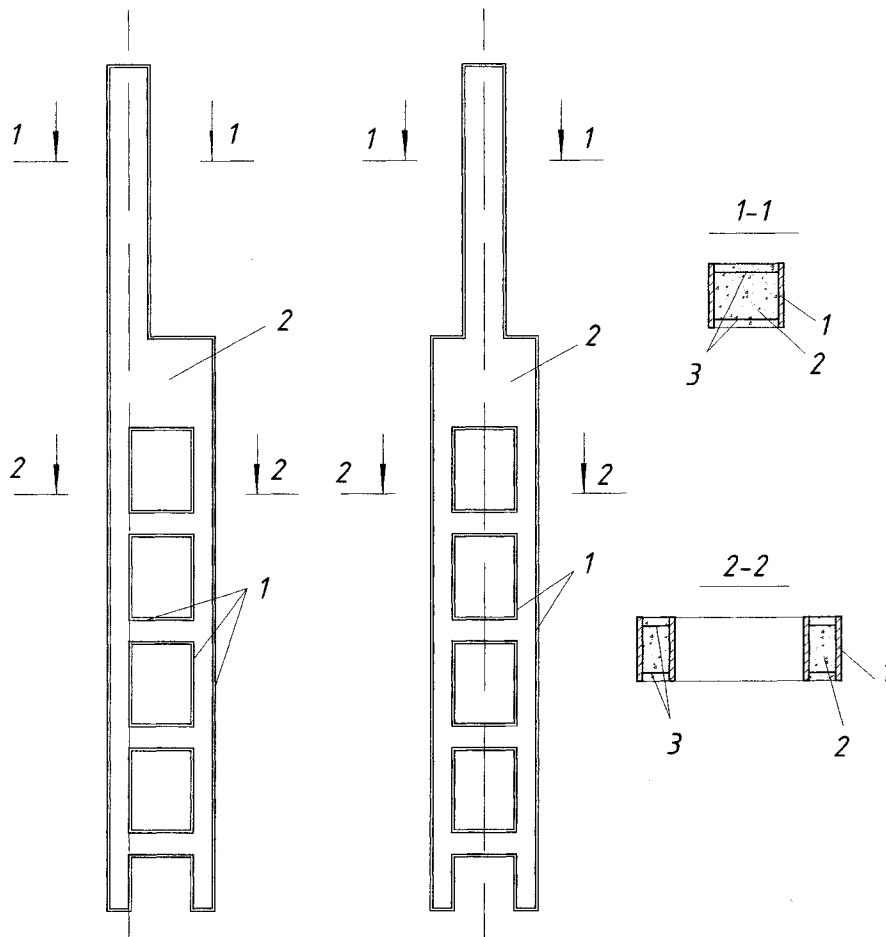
Наскрізна сталезалізобетонна колона із зовнішнім листовим армуванням
